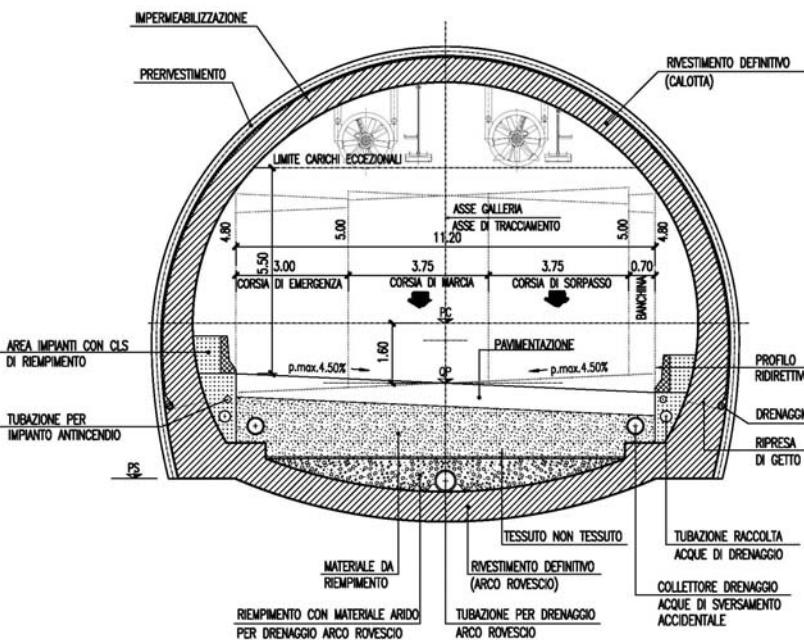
Sezione tipo in galleria naturale con scavo tradizionale
